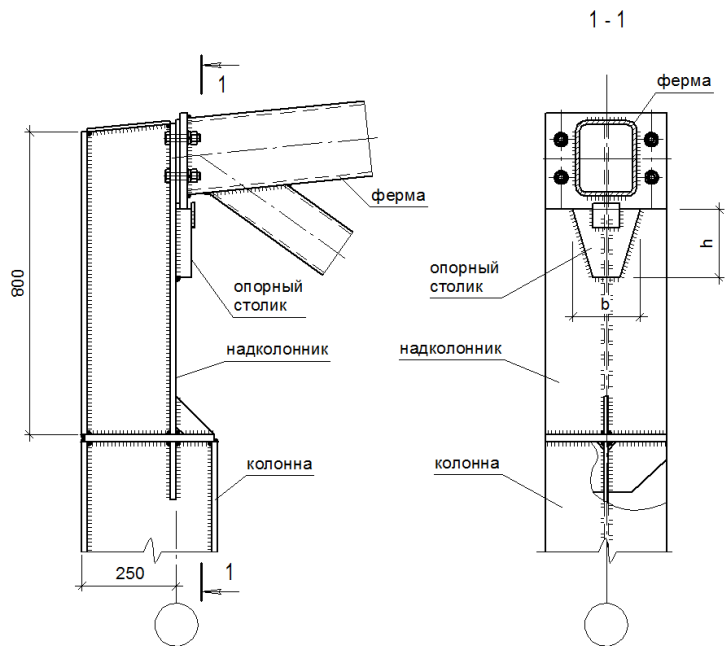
Узел опирания фермы на колонну крайнего ряда.
